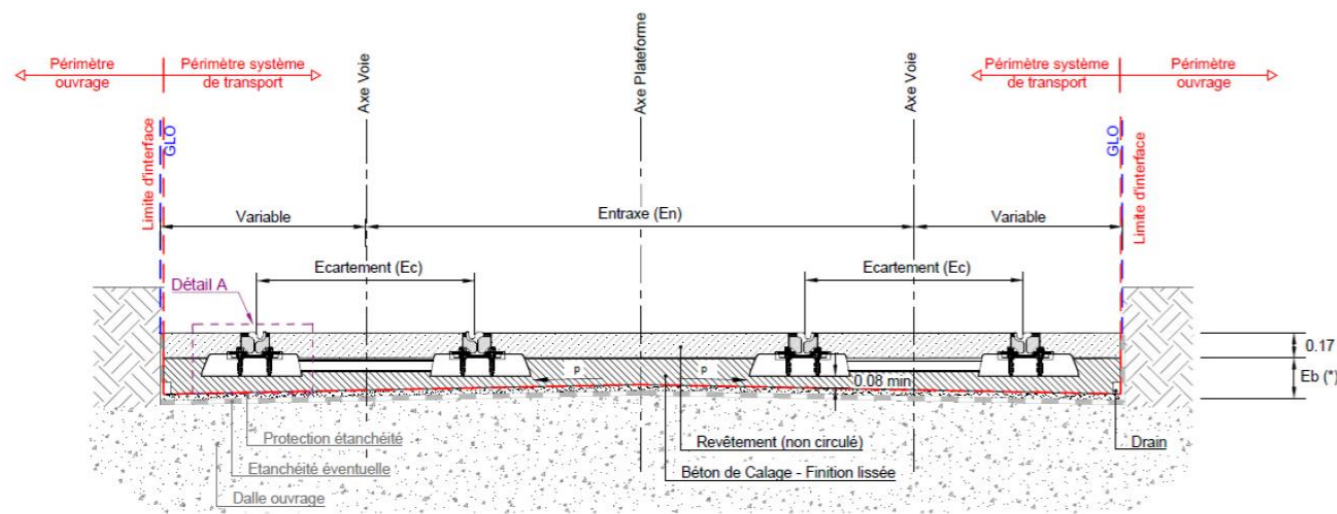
coupe type d'une plateforme - Voie béton traverses – Sans béton de fondation sur ouvrage
